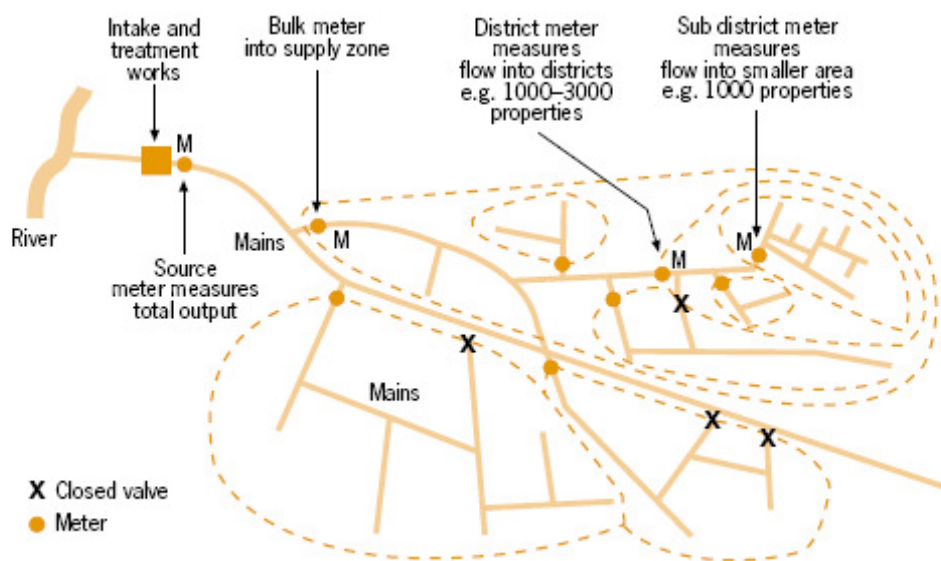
Plan al ierarhiei zonelor de contorizare de district si masurare a pierderilor de apa
